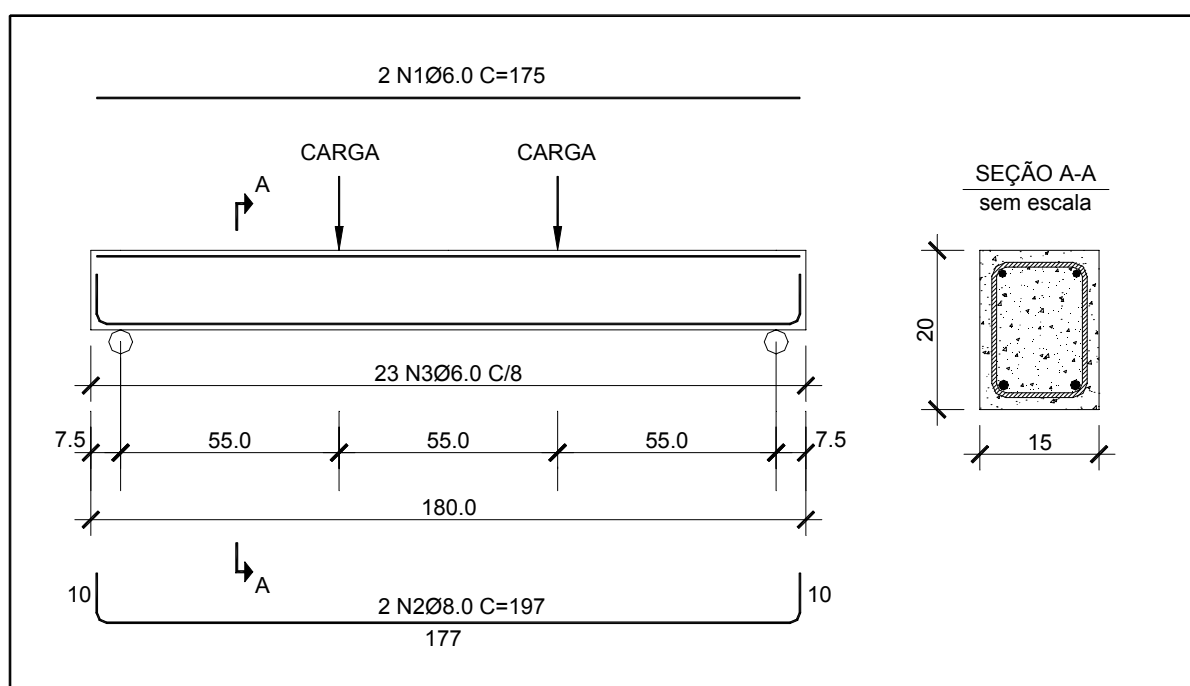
Dimensões e detalhamento das armações das vigas VRE, VR7 e VR8
